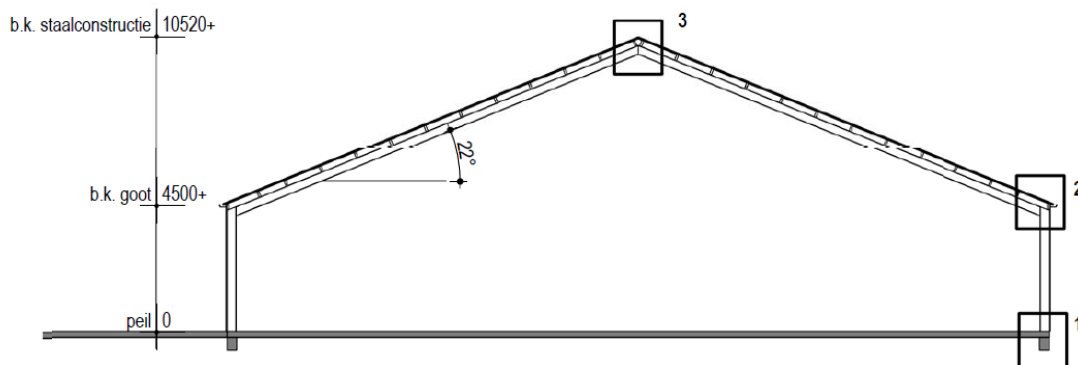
Vooraanzicht te bouwen loods (bron: Bouwkundig Bureau Haverkamp B.V.)
